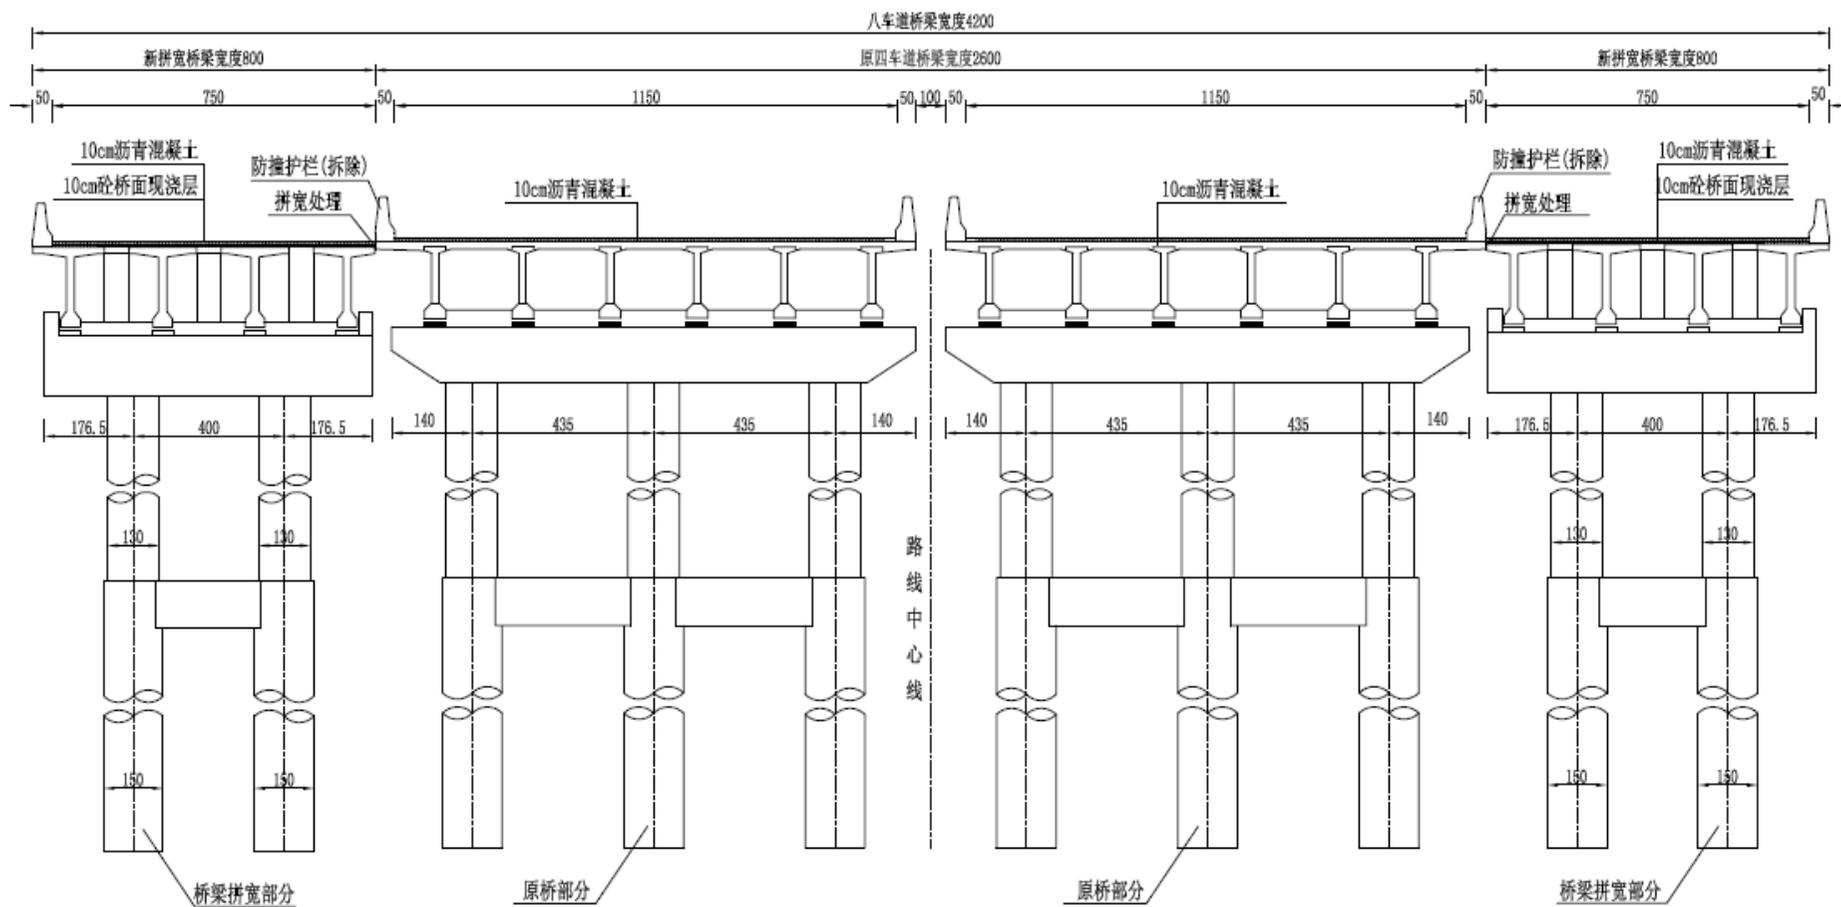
T 型组合桥梁加宽标准横断面图 (26m—42m)
